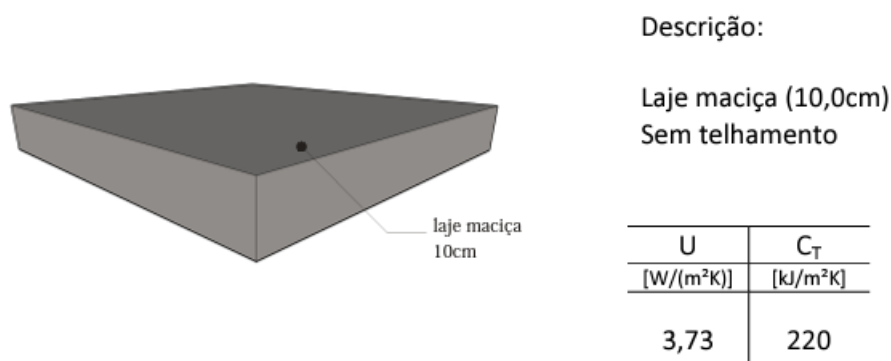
Laje maciça de 10cm de espessura, sem telhamento.
